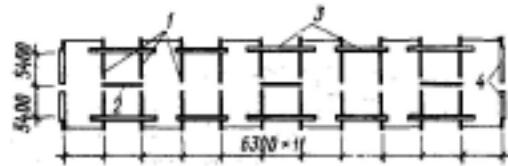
Крупнопанельный 17-этажный жилой дом с широким шагом поперечных стен. Конструктивная схема:
